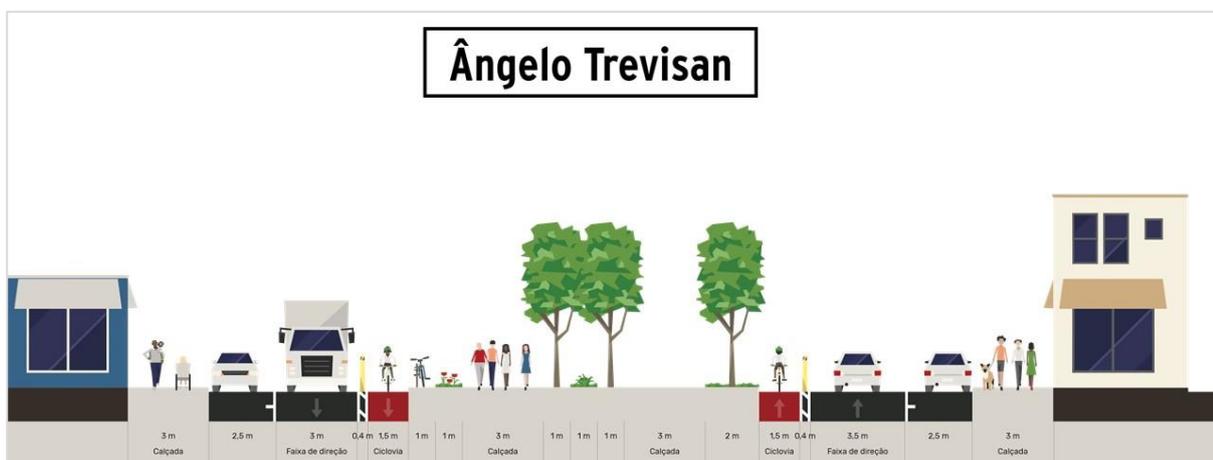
Proposta para a Avenida Ângelo Trevisan. Fonte: StreetMix. Elaboração: Polo Planejamento.
